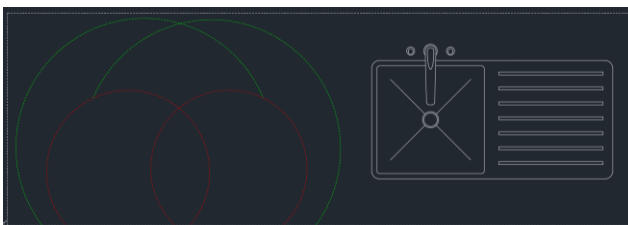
Plano horizontal de trabajo en encimeras y/o zona de preparación
